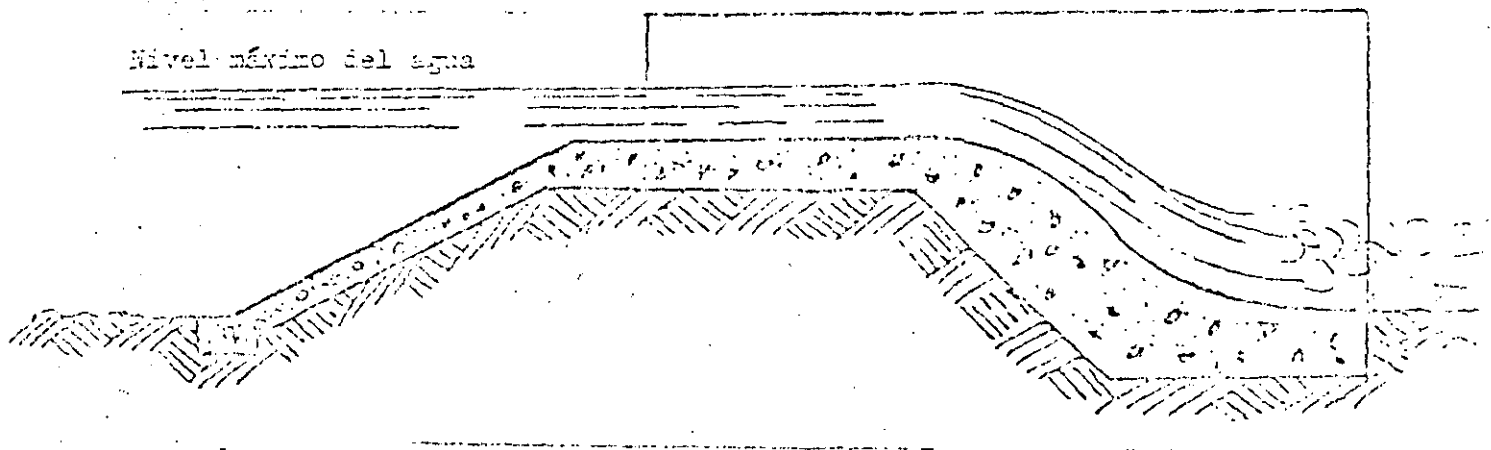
Rebosadero de concreto para una presa con relleno de tierra.
